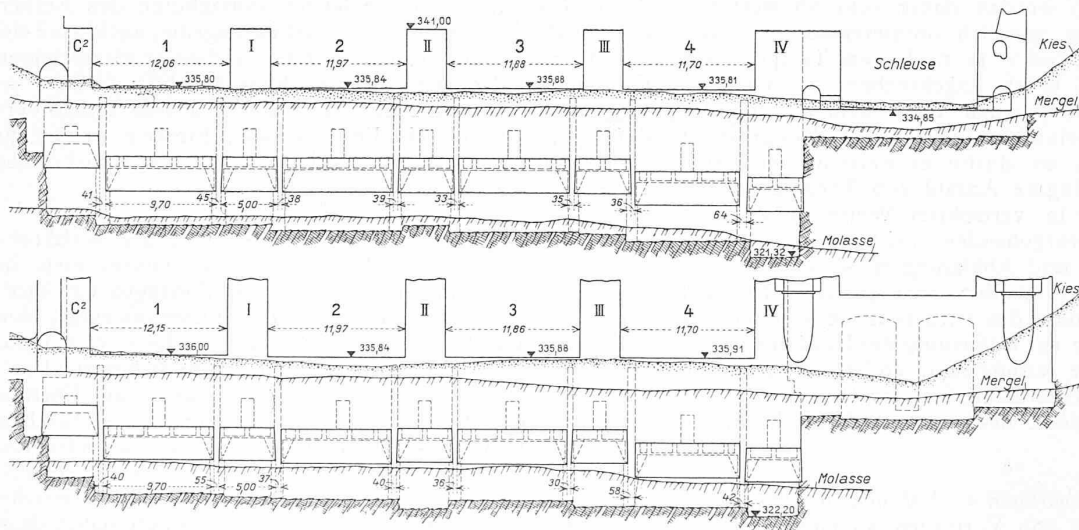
Längsschnitt der Wehrfundation, oben flussabwärts, unten flussaufwärts; Caisson-Schneiden in Enlage. — Masstab 1 : 600.
